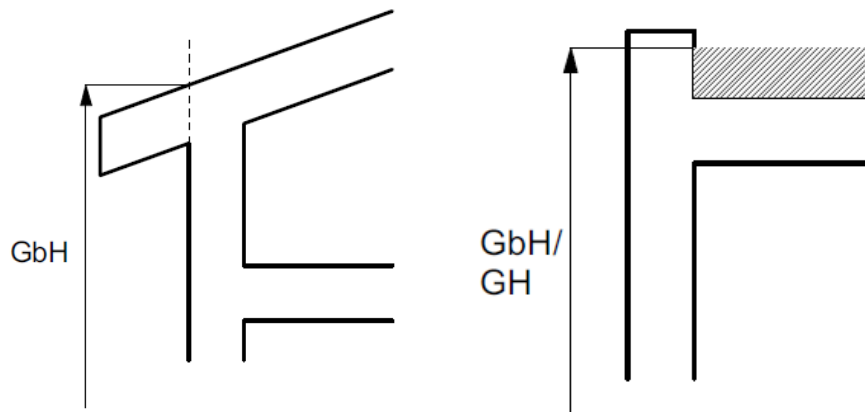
Gebäudehöhe, Dachraum, Gesamthöhe
